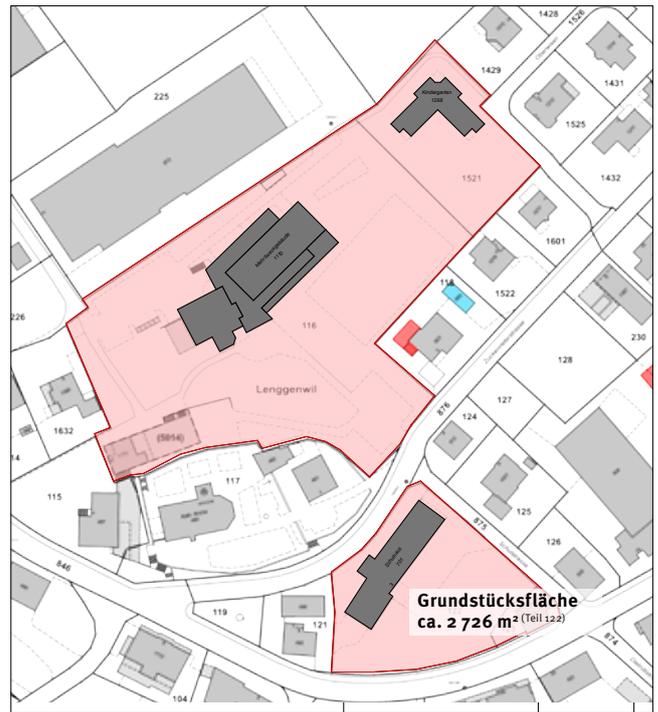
Situationsplan Lenggenwil, inkl. Flächenangaben
